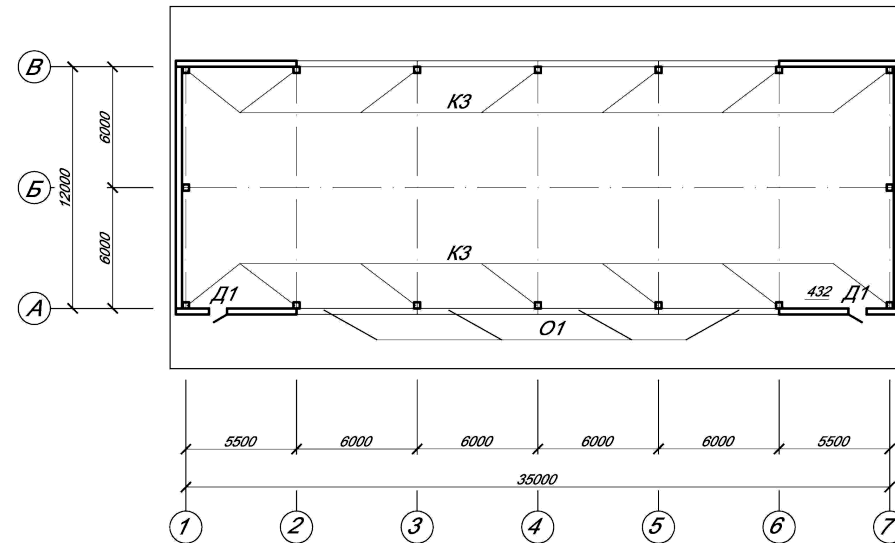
Конструктивна схема надсилосного поверху.
